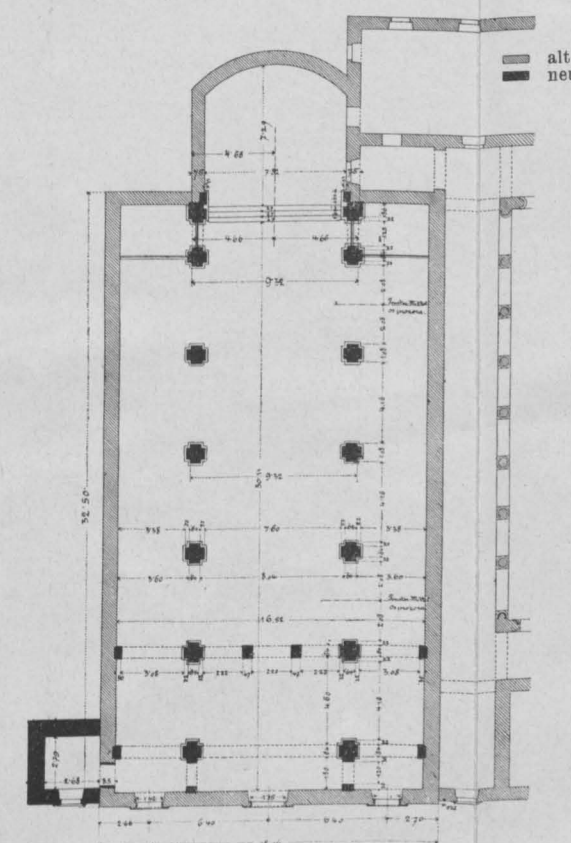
Grundriss zu Fig. 10. 1:400.
